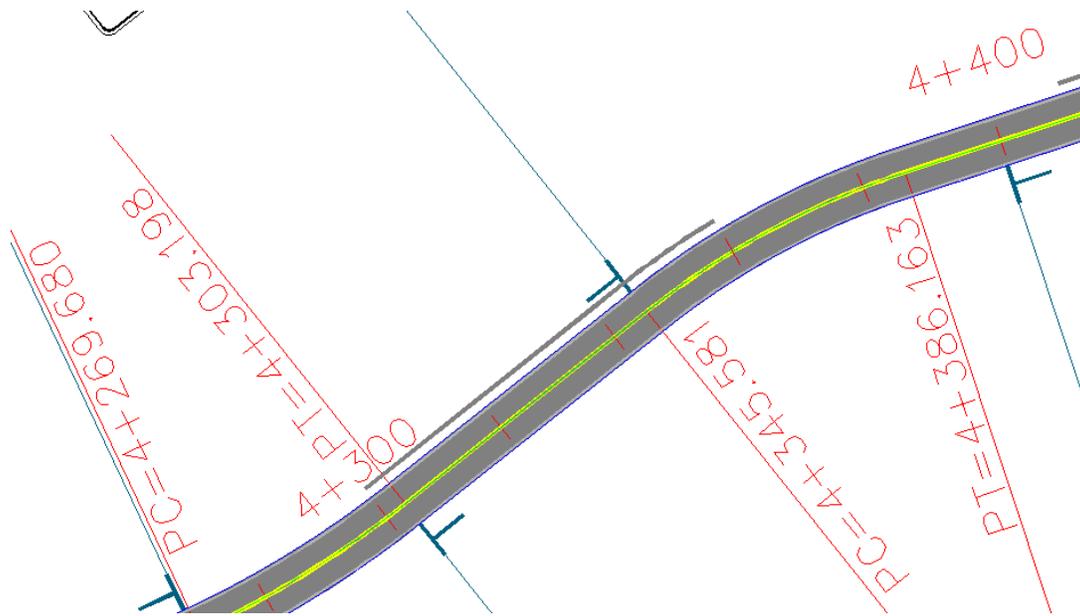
Vista en planta de señalamiento de defensa metálica lado izquierdo.
